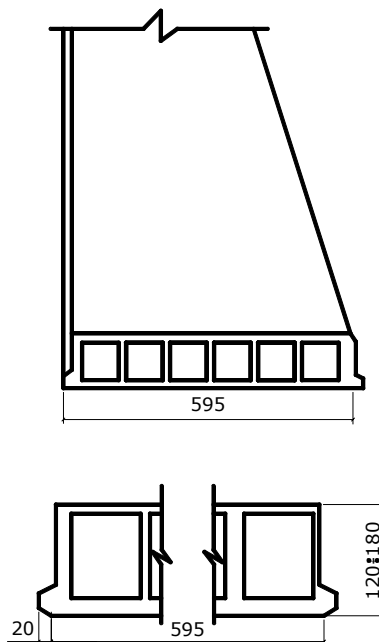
Плита покриття азбестоцементна екструзійна
